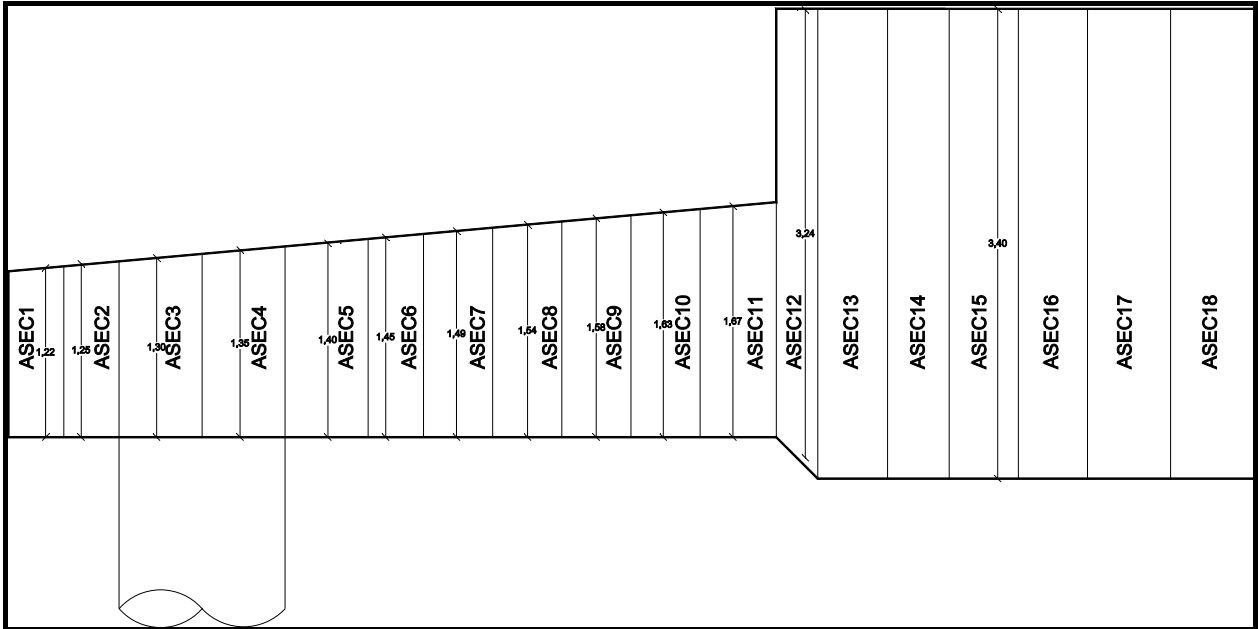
Sezione plinto di fondazione con individuazione dei conci e relative altezze
